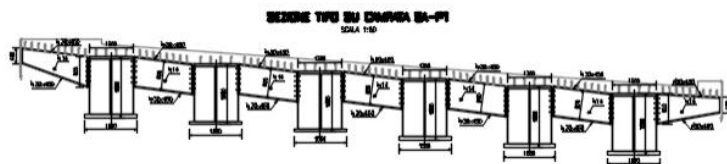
Struttura impalcato - Sezione trasversale tra SpA e pila P1
